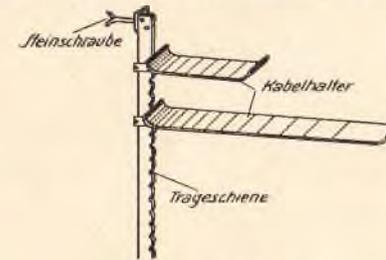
Kabelhalter in einem Mauer- oder Betonschacht
